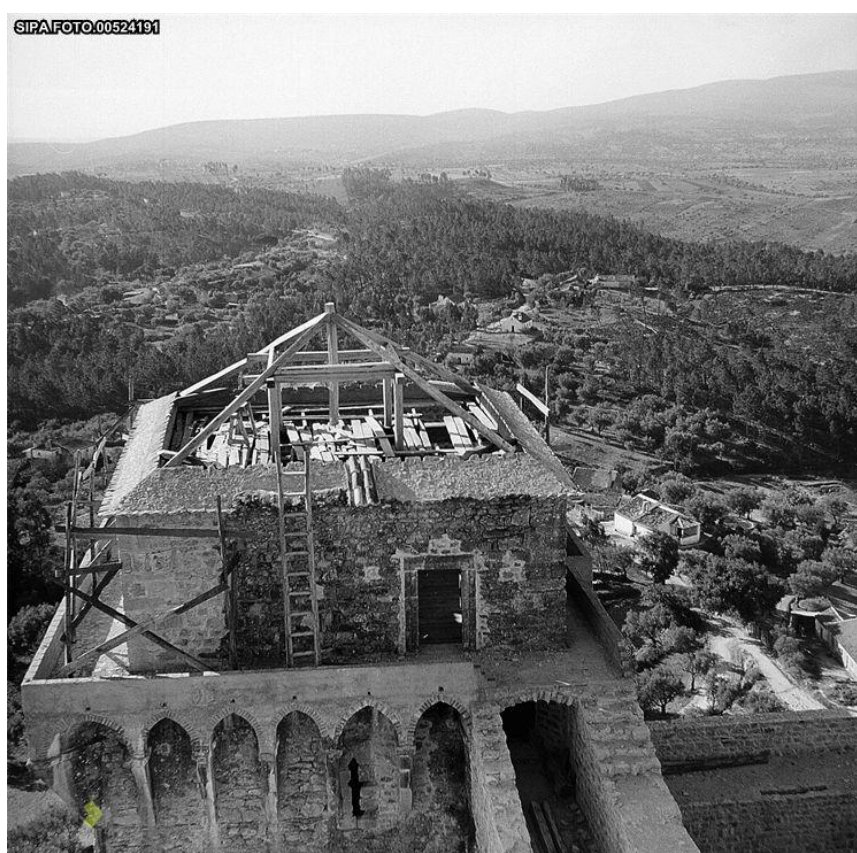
Obras de restauro no Torreão Nascente. Fonte: SIPA.
